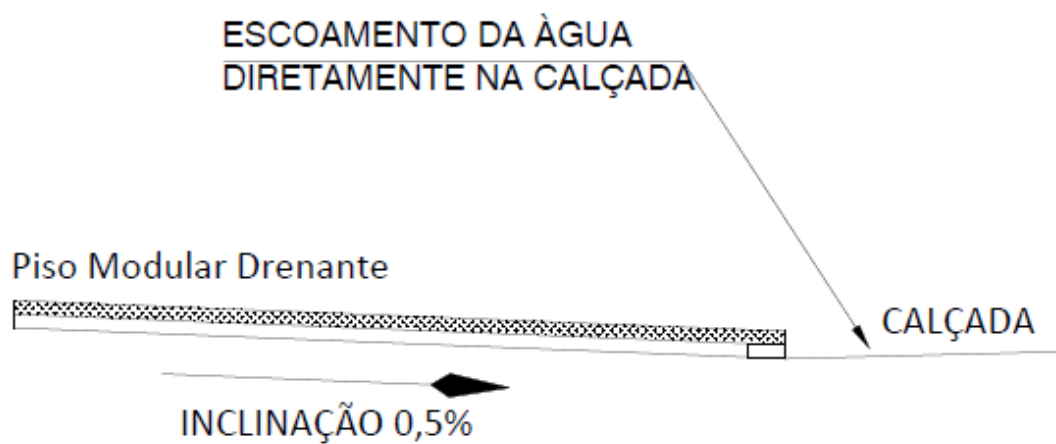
Detalhe inclinação (Fonte: Autor/2025)
